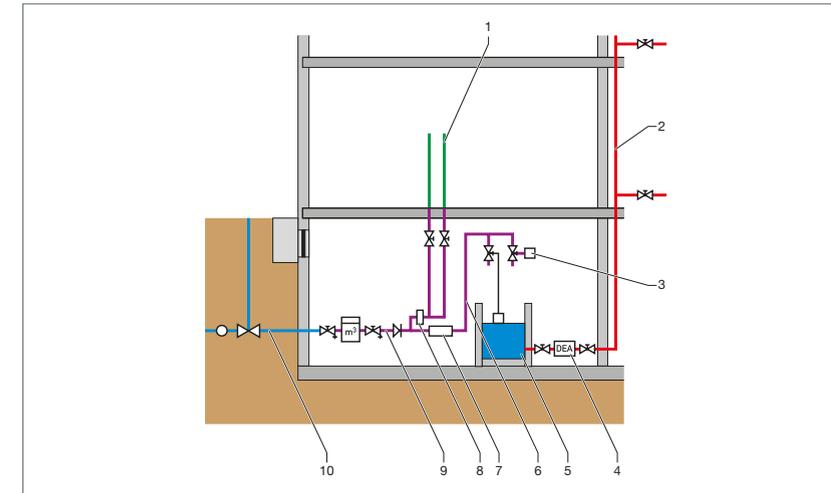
LWÜ mit mittelbarem Anschluss an die Trinkwasser-Installation
